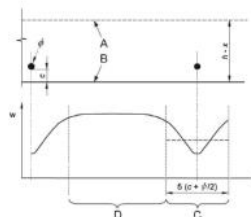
Ampiezza delle fessure,  $w$ , in funzione della posizione rispetto alle barre di armatura
